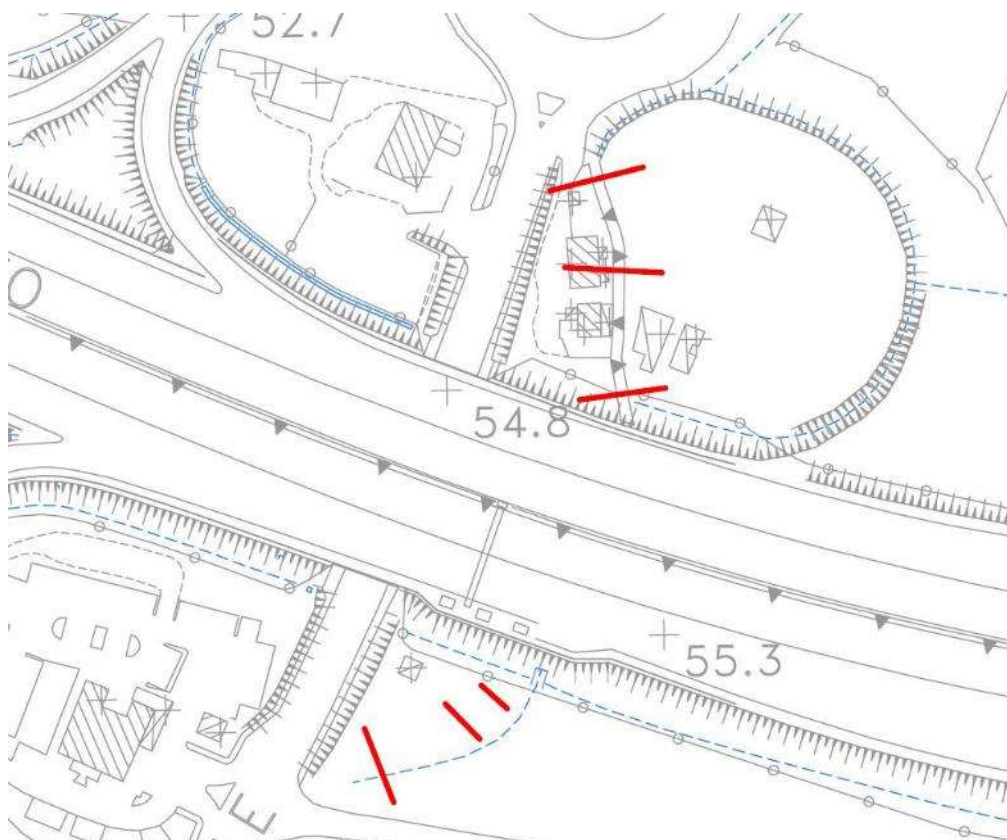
Planimetria sezioni HEC-RAS, Rio Zinella
